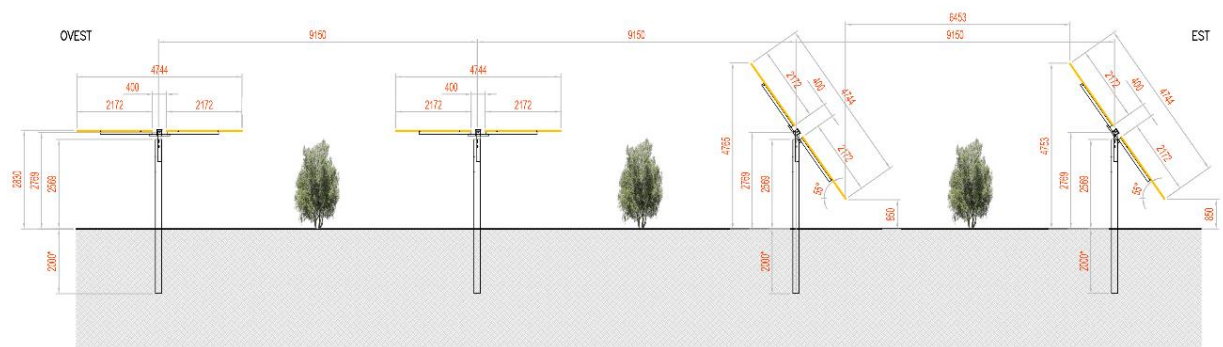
Tipologico – Vista Planimetrica dell’impianto Olivicolo
